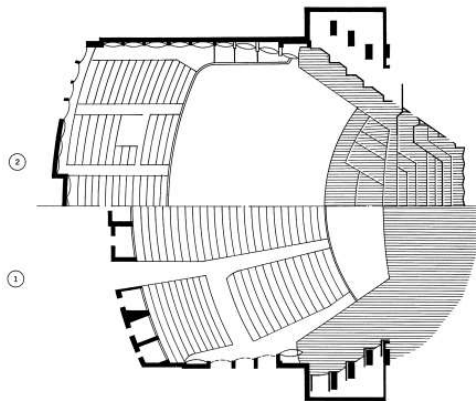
Grundriss [Beranek 2004, S. 171]
